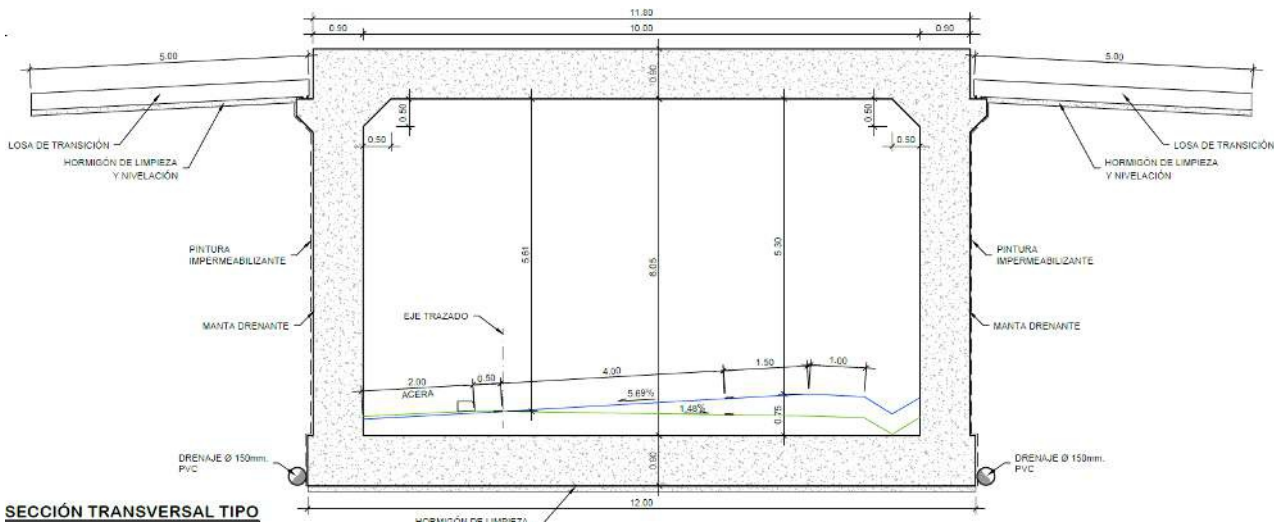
Sección transversal. Estructura E-4. Solución marco
